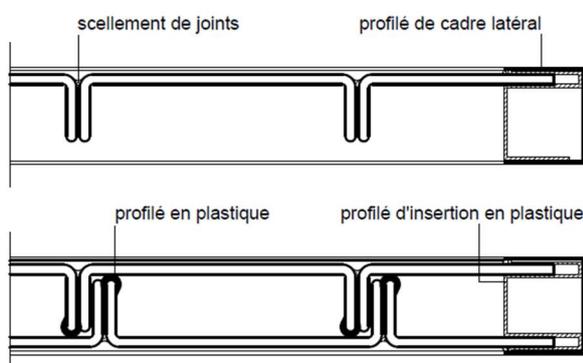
coupes verticales et horizontales de pose en une ou deux couches
